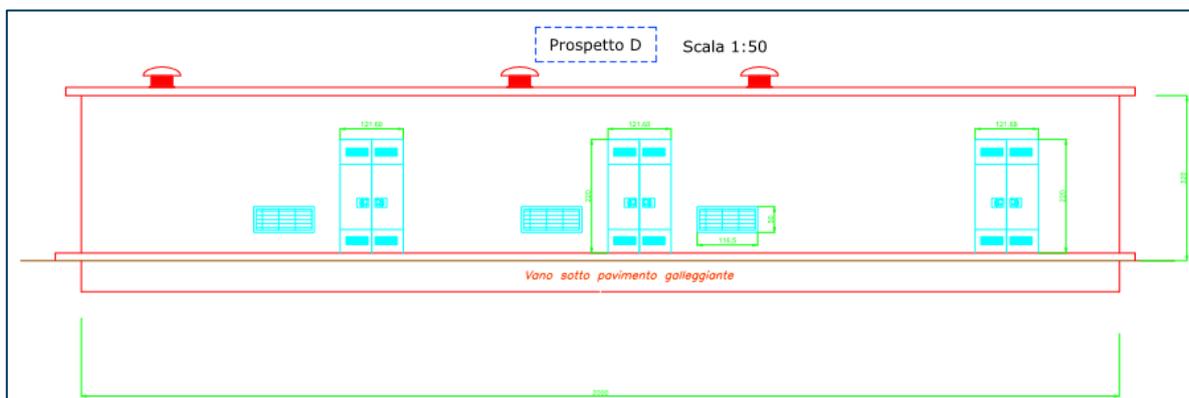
Prospetto lato strada della cabina di consegna dell'Area Nord di Impianto
